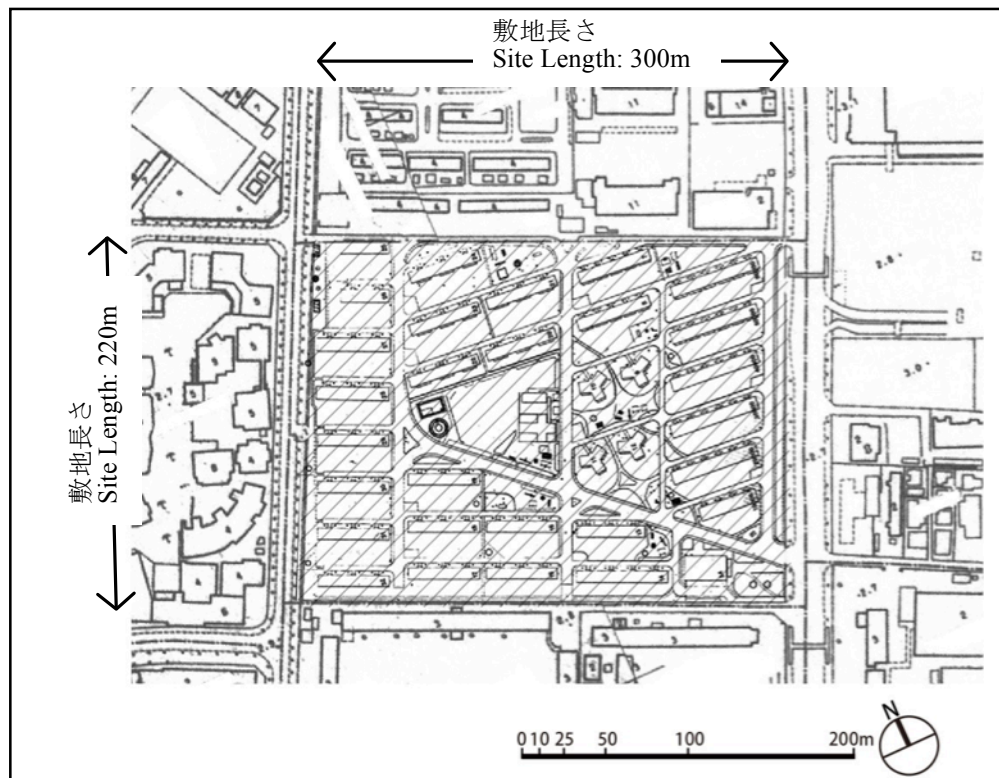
計画対象の住宅団地の現在の配置図 (出典：福岡市 1/2,500 白地図)
